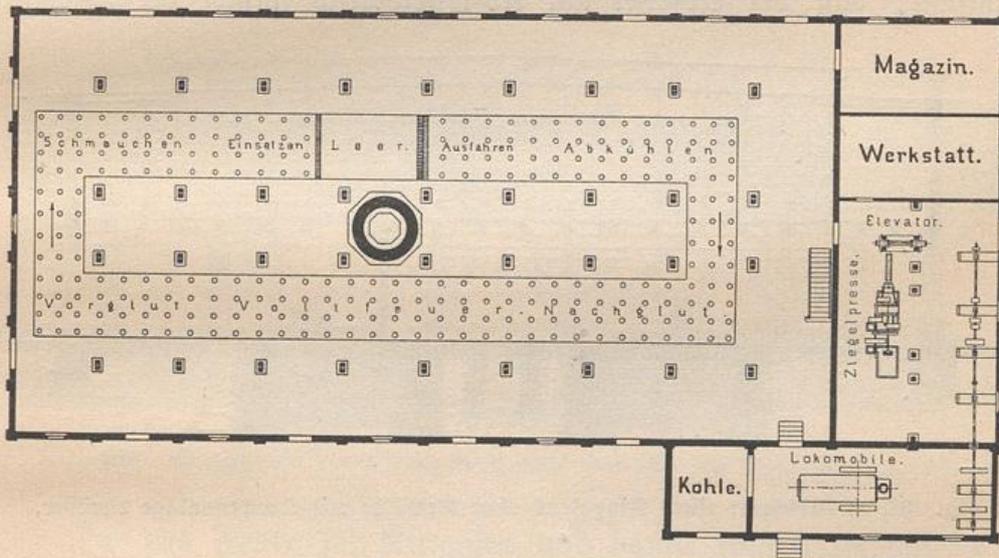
Grundriß einer Dampfziegelei mit Ringofen ohne Gewölbe.
